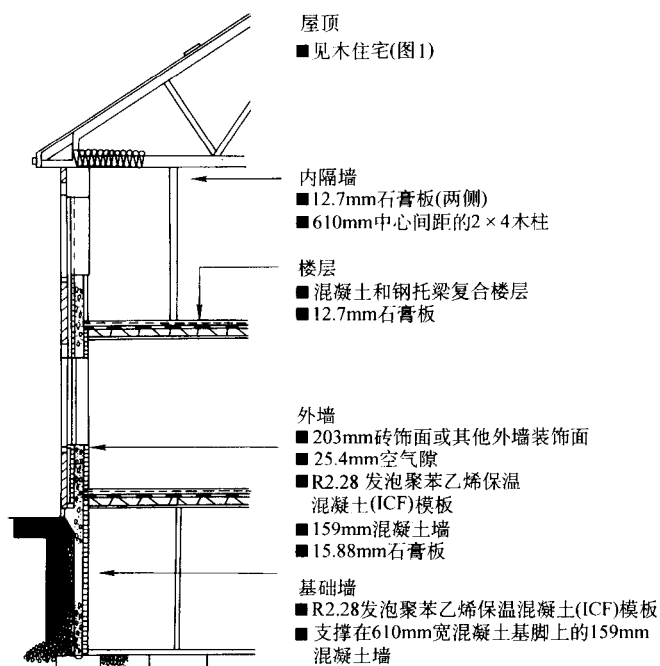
混凝土(砌块墙或保温混凝土成型墙)住宅剖面
